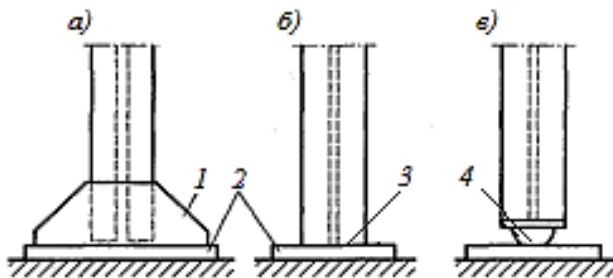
Типи баз колон: *a* - з траверсою; *б* - з фрезерованим торцем; *в* - тангенціальна опора; 1 - траверса; 2 - опорна плита; 3 - торець фрезерування; 4 - центруюча плита
